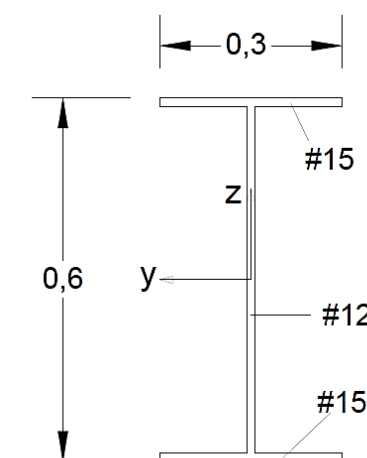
Sección transversal viga de piso en centro-luz de la misma. Elaboración propia con AutoCAD
